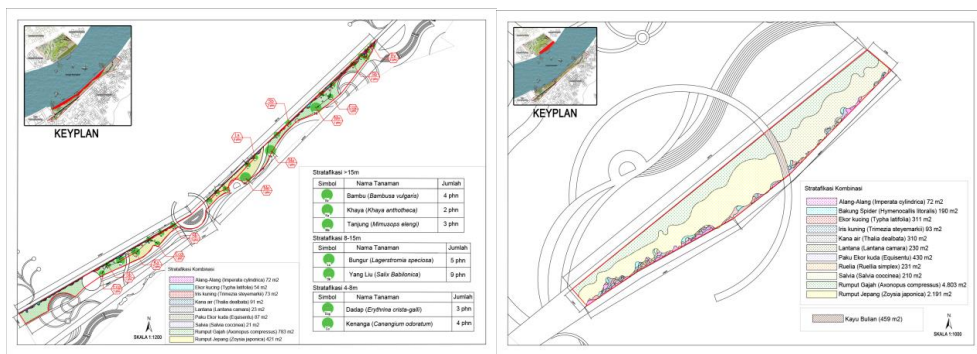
Hardscape dan Softscape Plan* Zona Komersial
